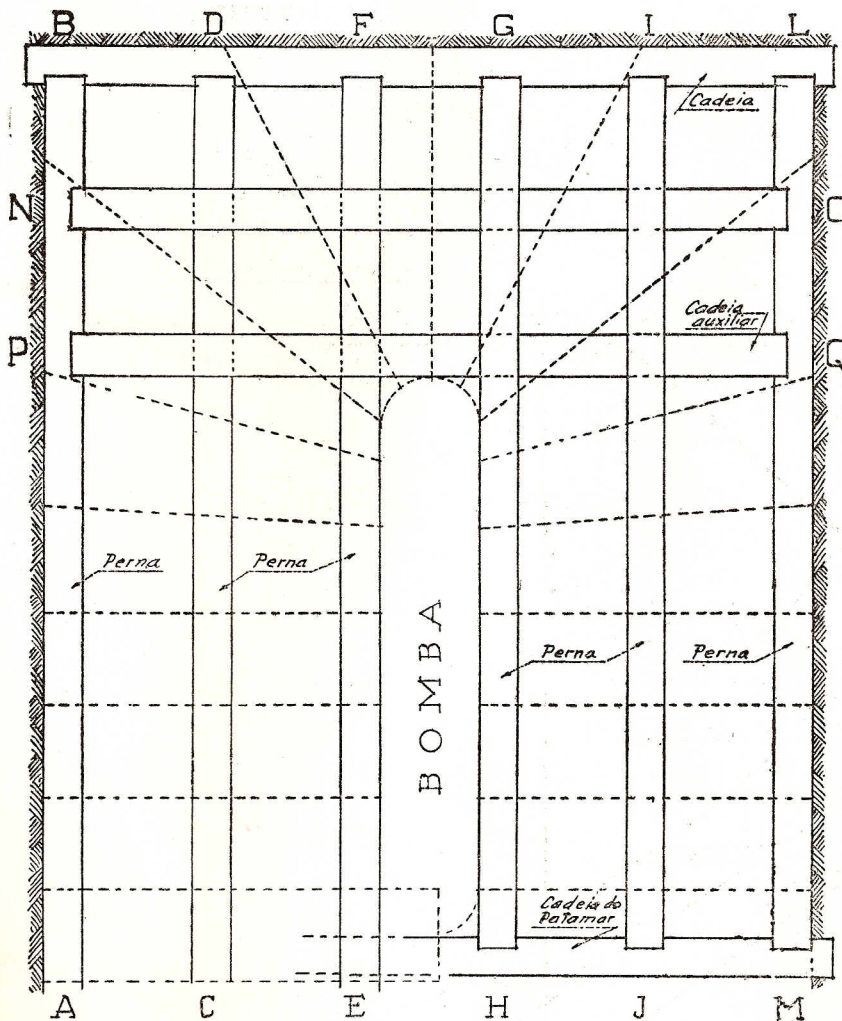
PLANTA DA ESTRUTURA DA ESCADA DE COMPENSAÇÃO
